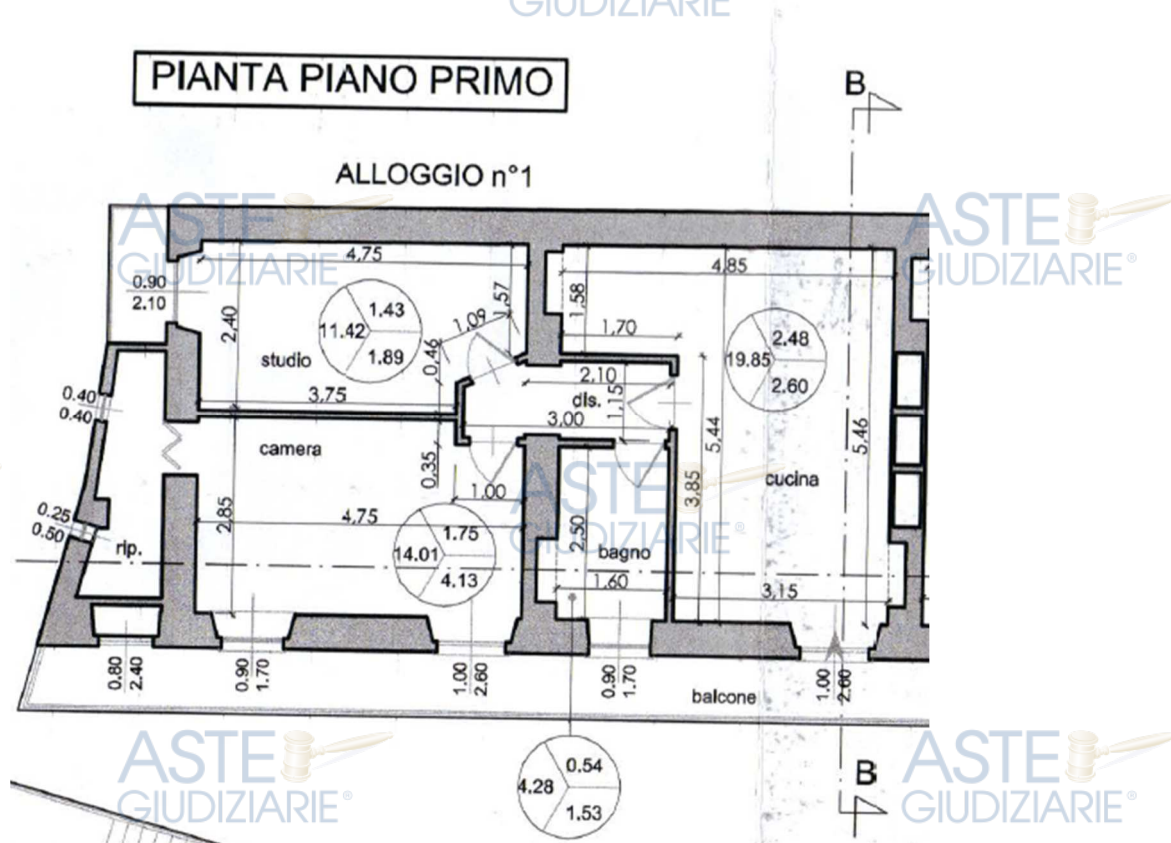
Estratto progetto piano primo D.I.A. 2009
